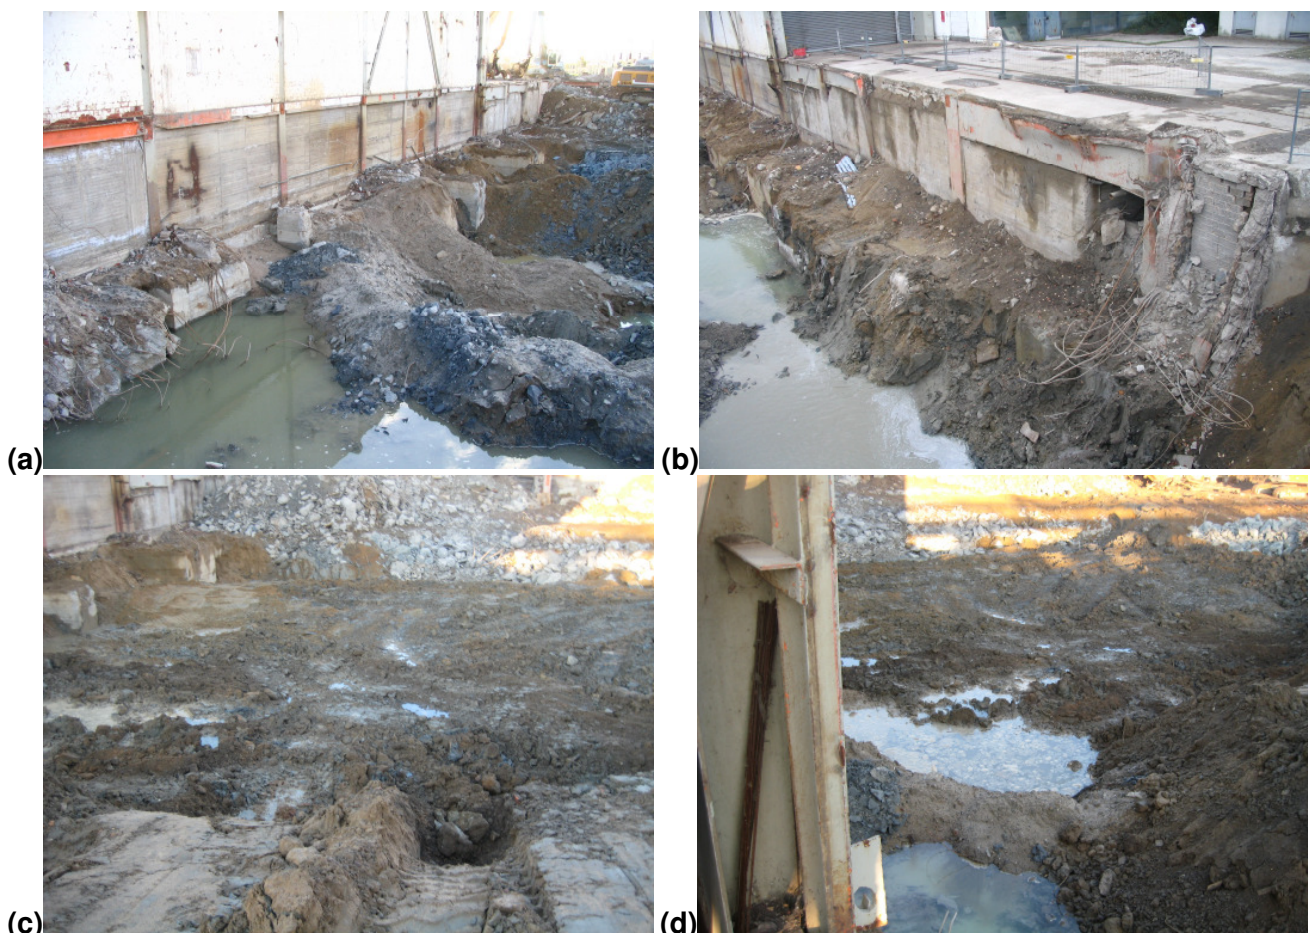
a – d Entfundamentierung und verbliebene Stahlbetonfundamente im Bereich des Sozialgebäudes Block I.
